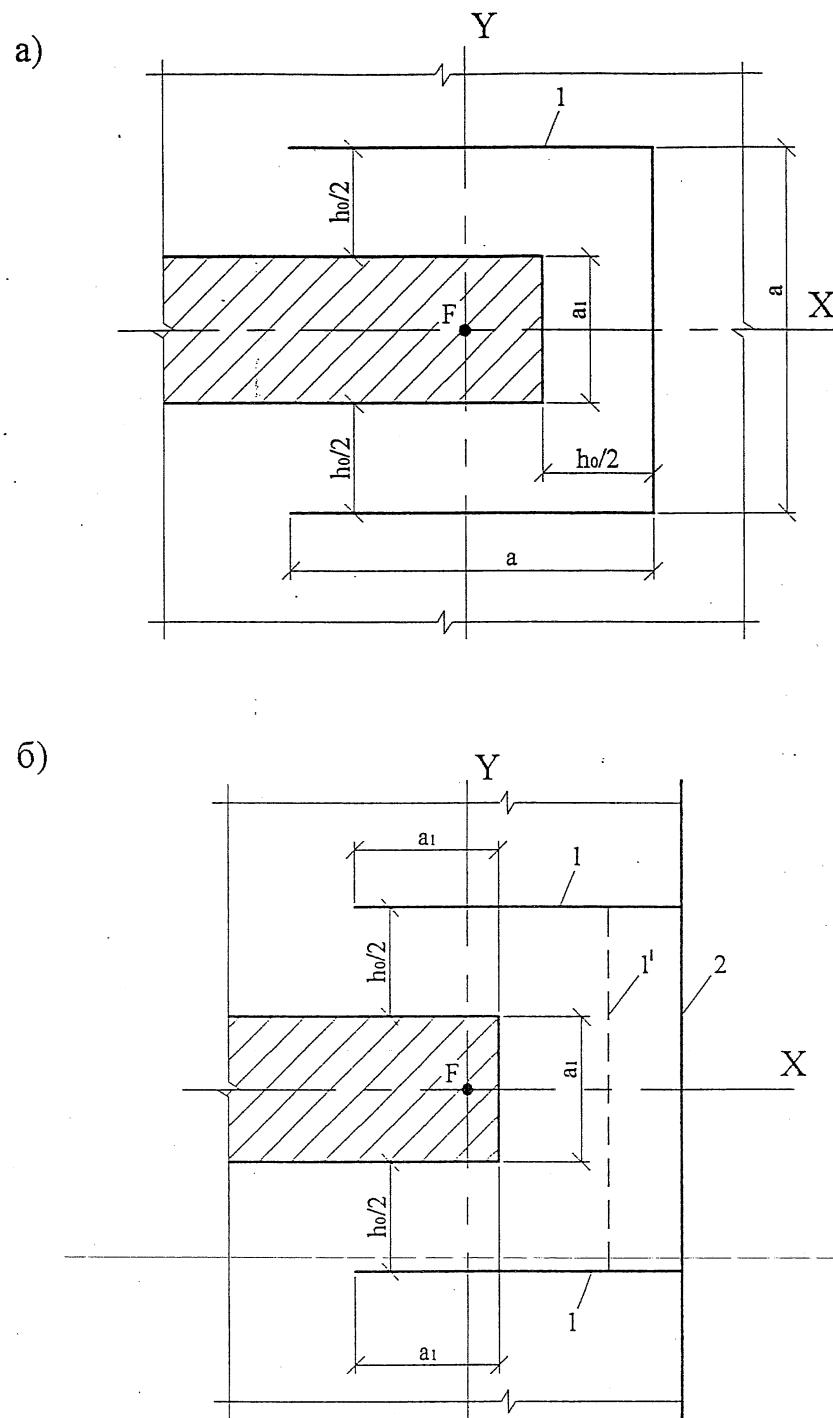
Схемы для расчета железобетонных плит на продавливание около стен, расположенных внутри площади плит (а), у края плиты (б)
